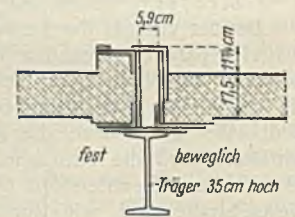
Dehnungsfuge in der Fahrbahndecke über einem Träger. Zufahrtrampen.
